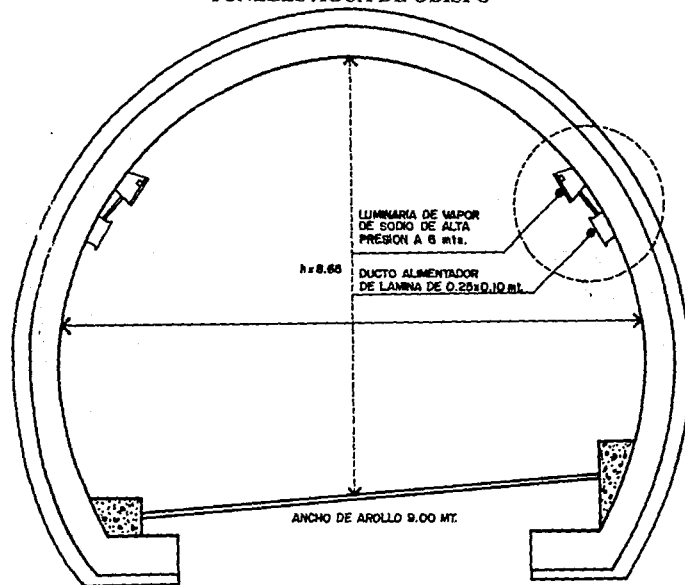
ILUMINACION DE LOS TUNELES Y UBICACION DE LUMINARIAS
